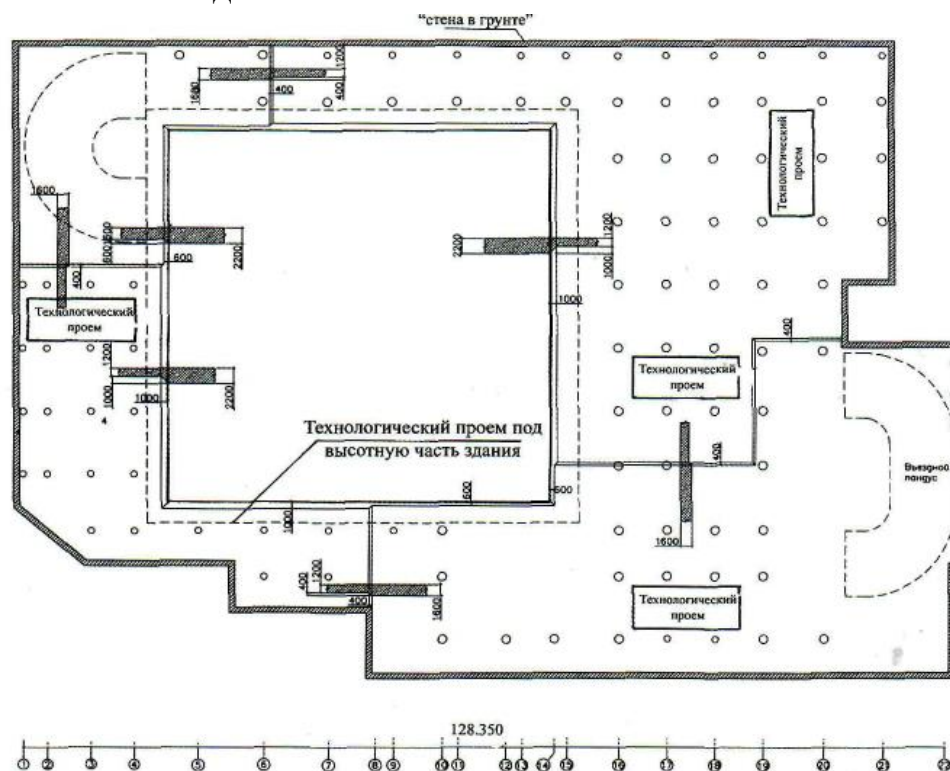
Общий вид строительной площадки при полузакрытом способе возведения здания
